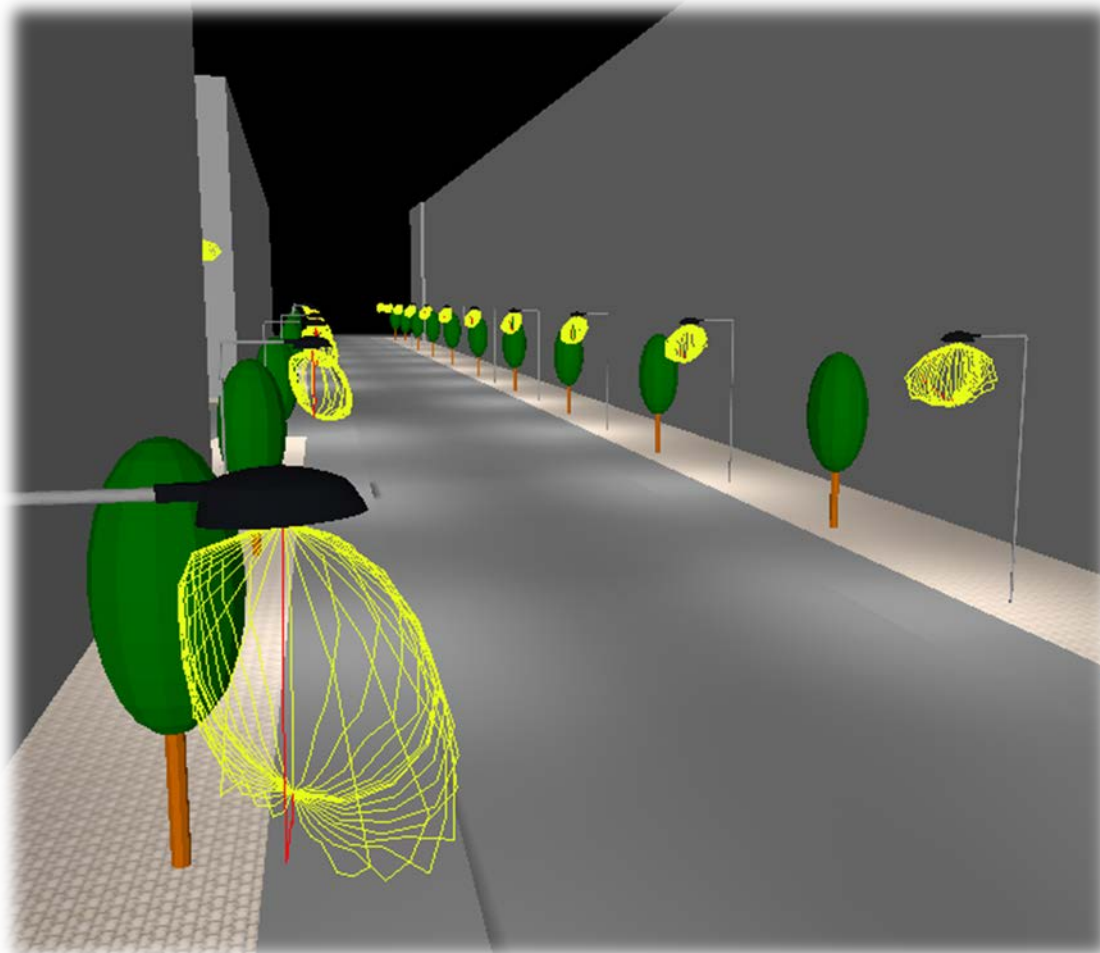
Vista tridimensional del diseño final de la calle Santa Maria Micaela
